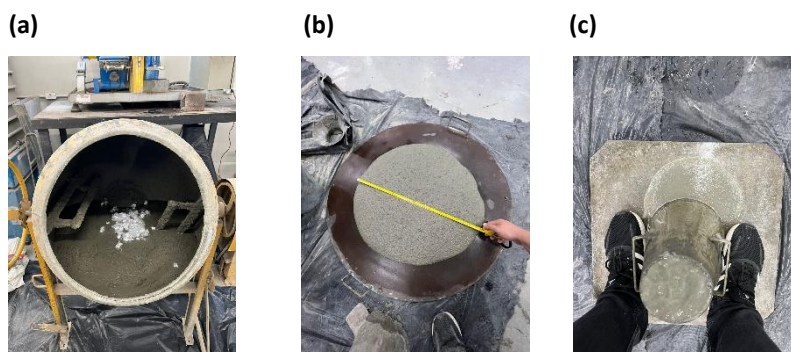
Ensaio do graute no estado fresco: (a) Mistura na betoneira, (b) Ensaio de espalhamento, (c) Ensaio de abatimento.
